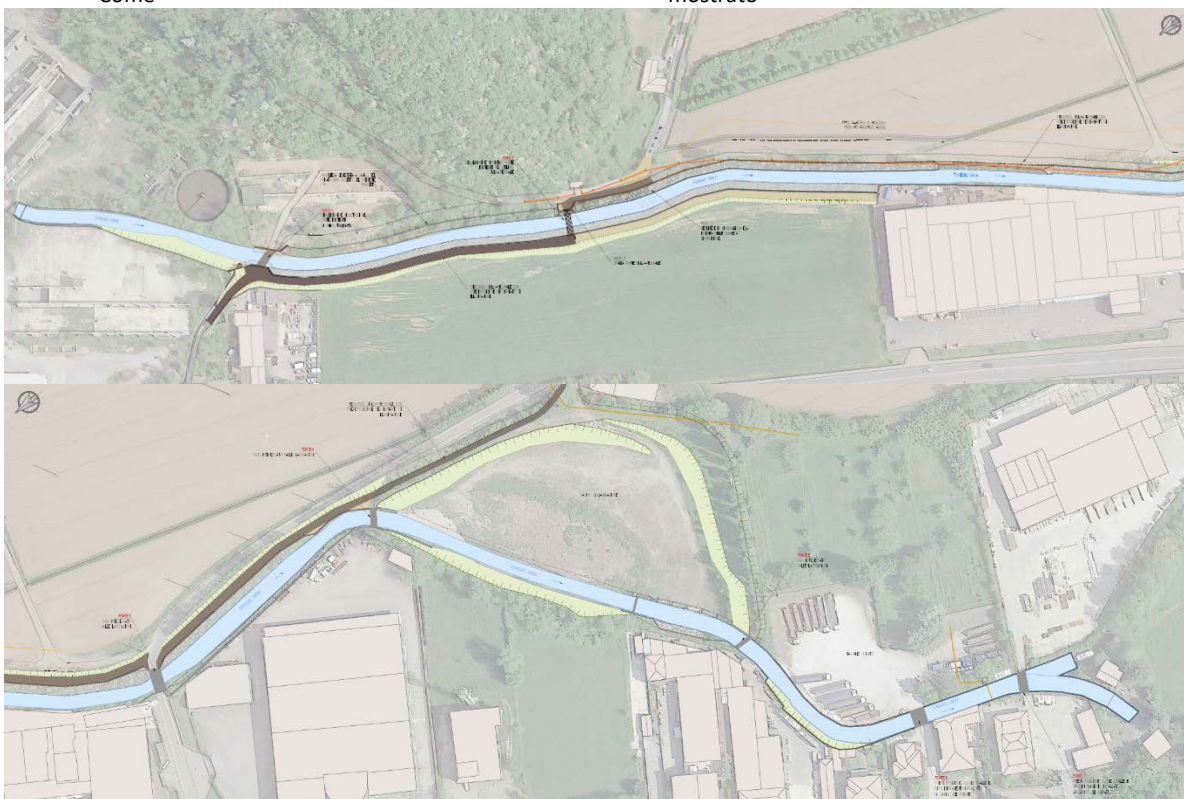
Estratto Tavola 04. Stato di progetto, planimetria generale.
